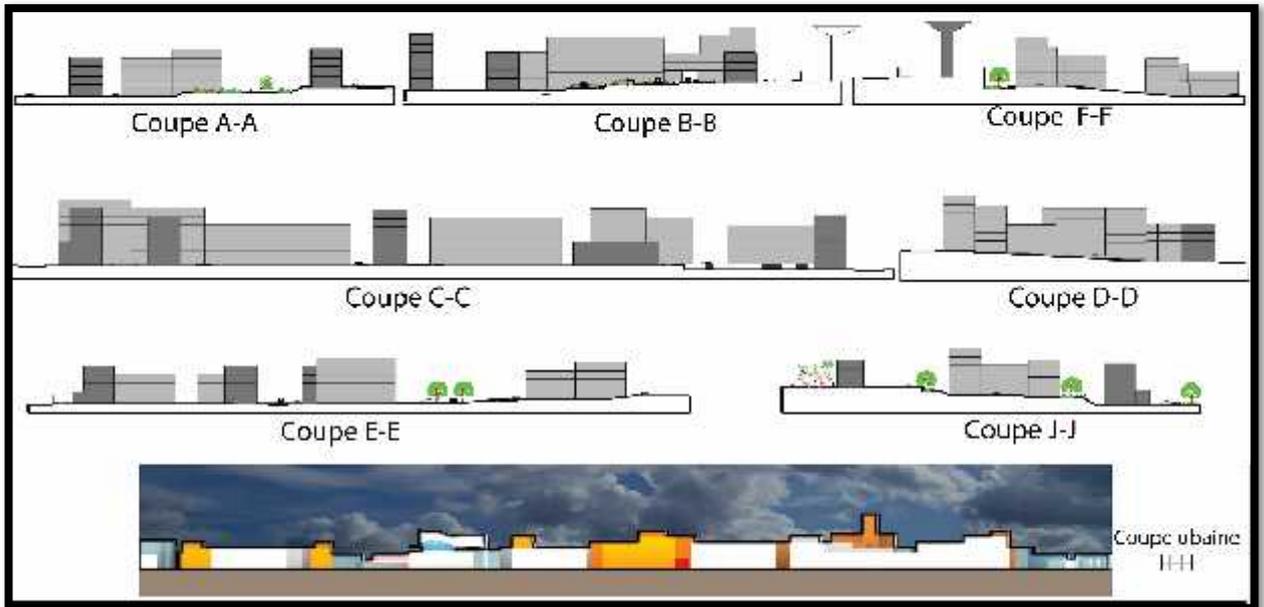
Coupes schématiques. Source : Benattallah et Ramdani, copyright
